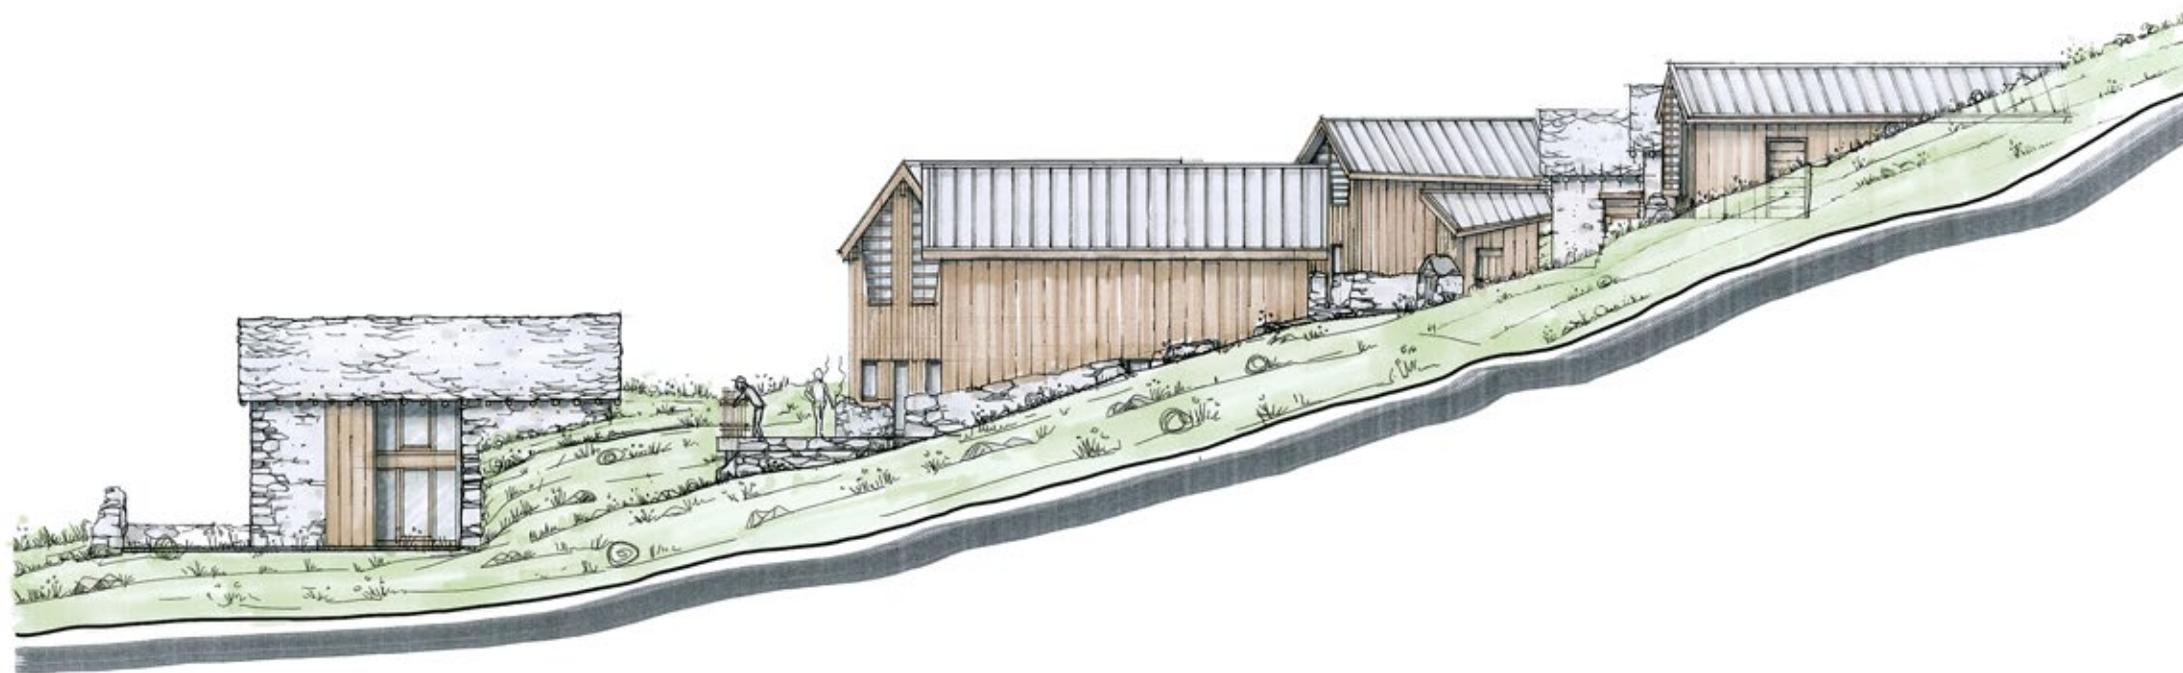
Sezione BB, vista dell'insieme laterale del mayen.
